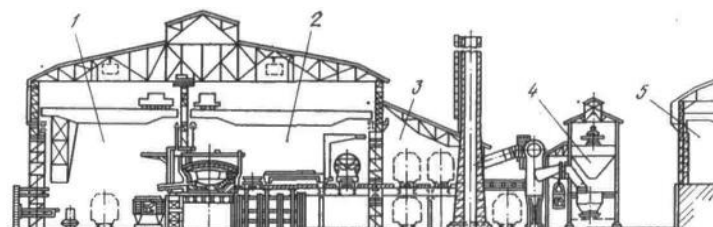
Мартеновский цех с рельсовой системой подачи шихты и отдельным расположением шихтового двора (поперечный разрез): / — разливочный пролет; 2 — печной пролет; 3 — шихтовый открылок; 4 — котлы-утилизаторы; 5 — шихтовый двор
